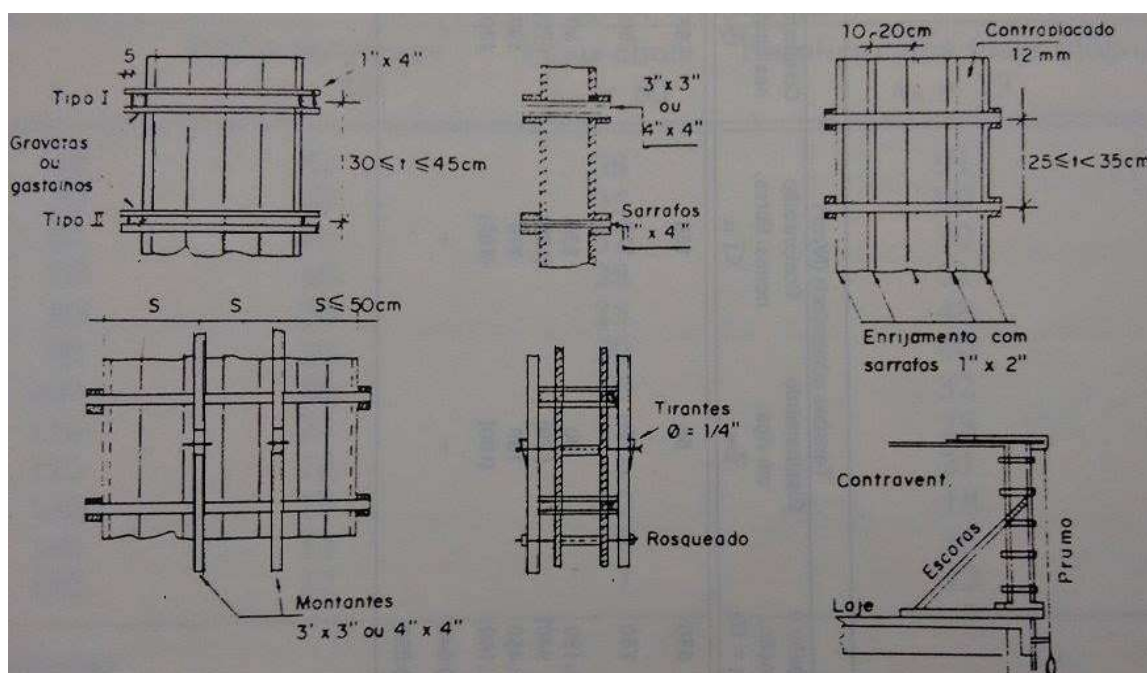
Detalhamento de fôrmas de madeira serrada para pilar.
